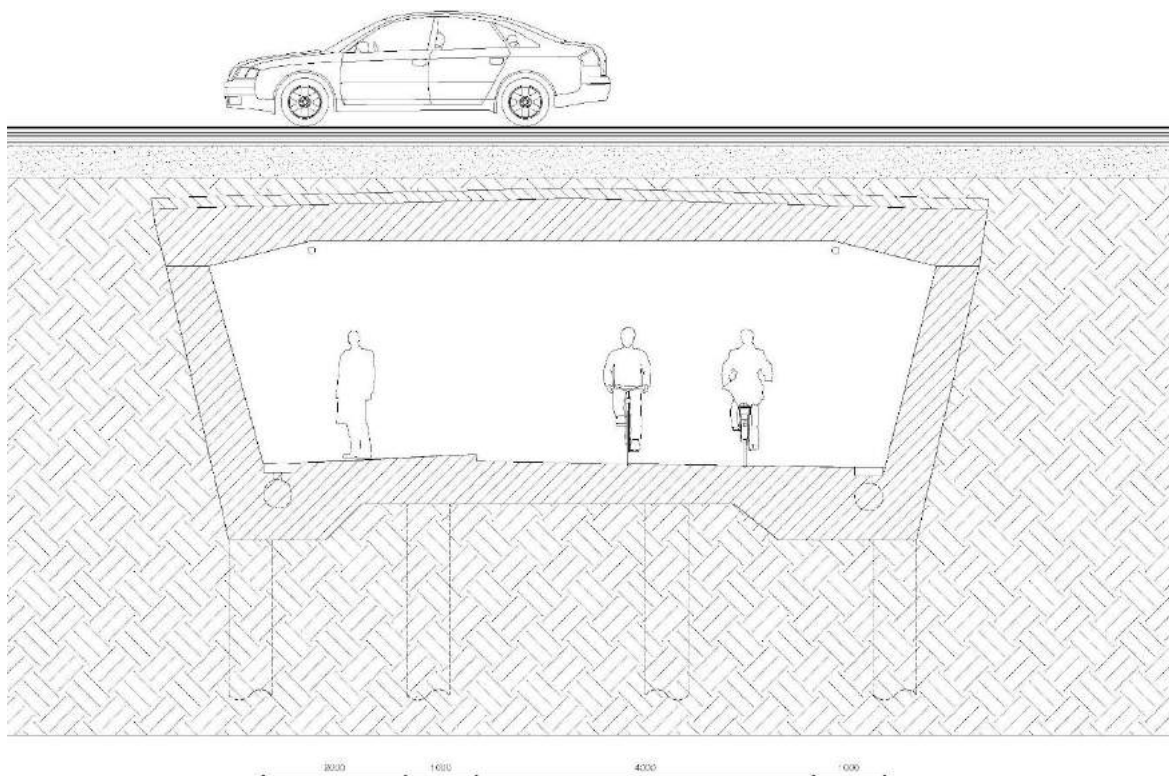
Conceptschets fiets- en voetgangerstunnel ter hoogte van halte Hermeslaan
